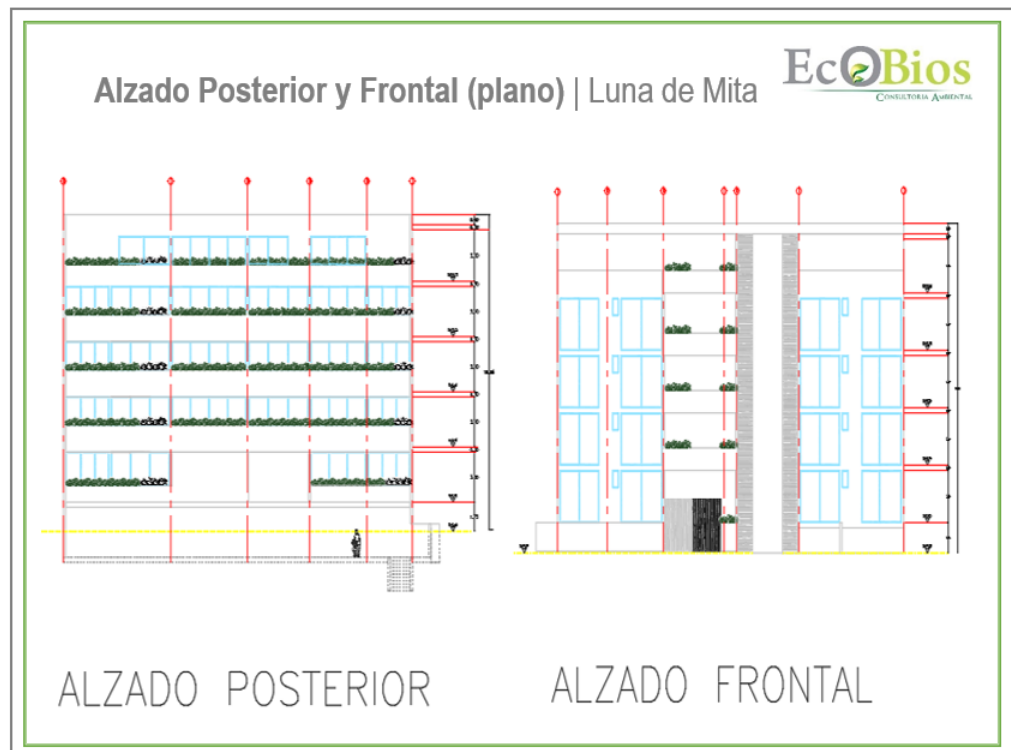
Alzado posterior y Alzado Frontal, Luna de Mita (plano estructural).
